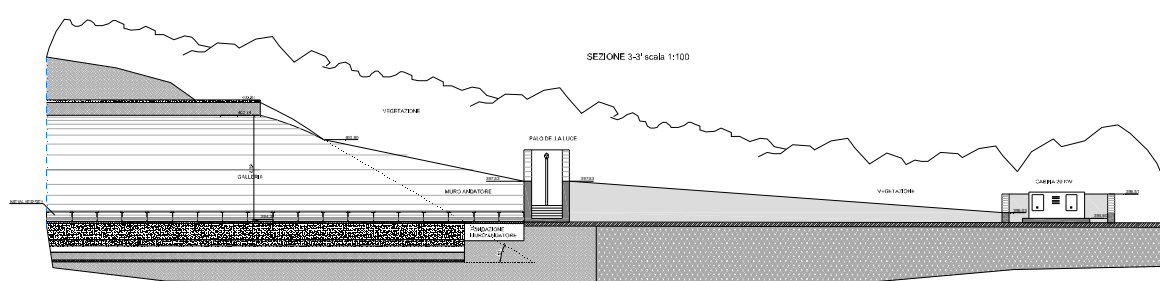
Sezione longitudinale galleria sx - imbocco lato Serino
